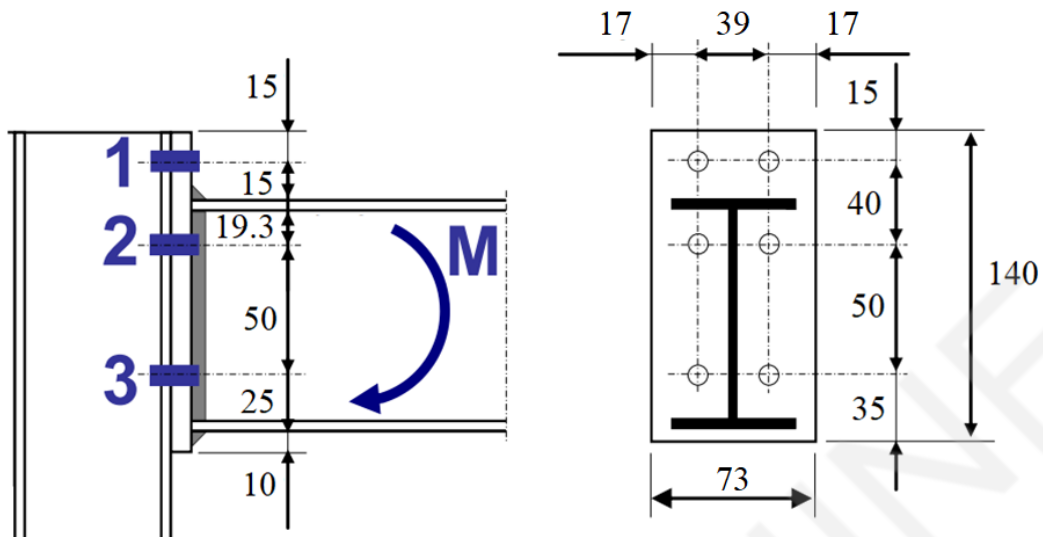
Configuration d'assemblage poteau-traverse (2)
